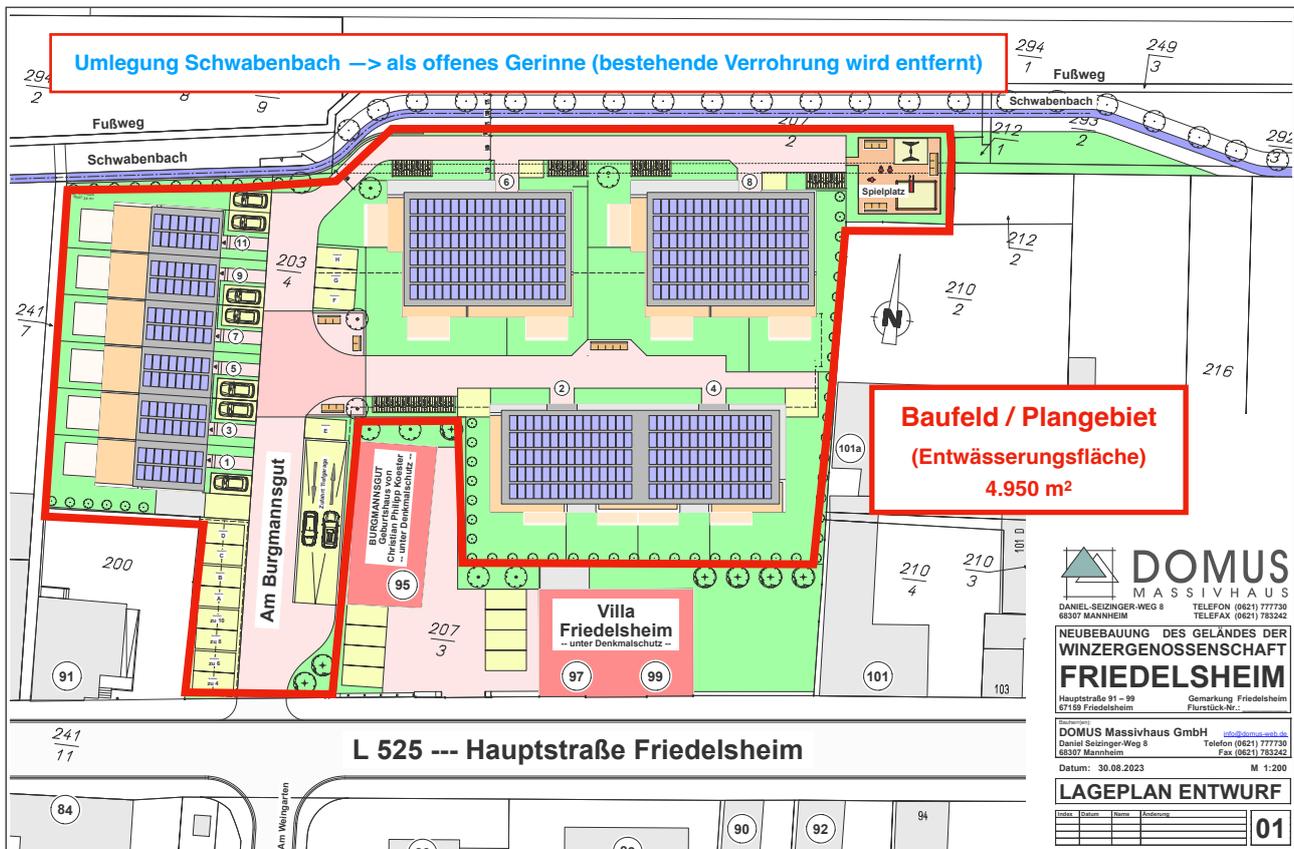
Lageplan Entwurf - Baufeld (Bild Quelle: Domus Massivhaus GmbH)
